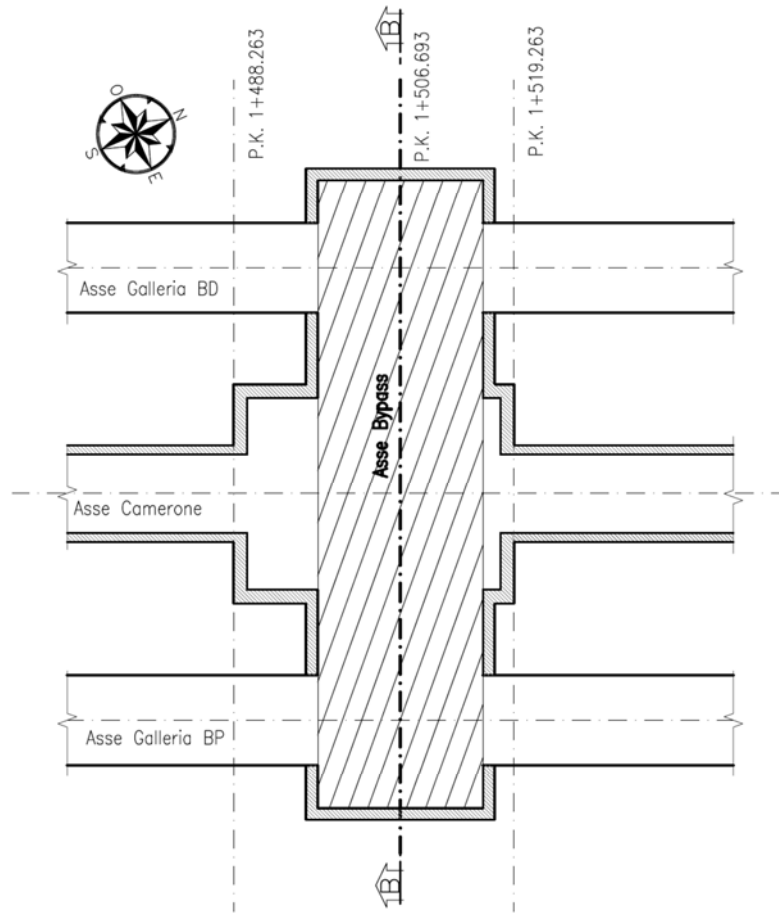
Camerone smontaggio TBM, fase 7, profilo longitudinale, planimetria, layout in pianta.
